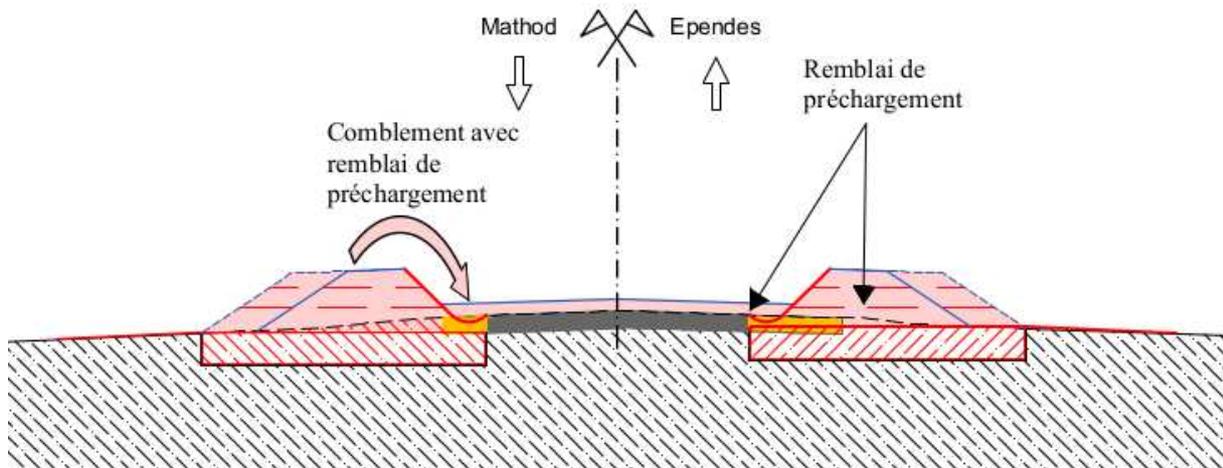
Coupe sur rampe d'accès du pont sur le Mujon avec remblais de préchargement (route fermée)
